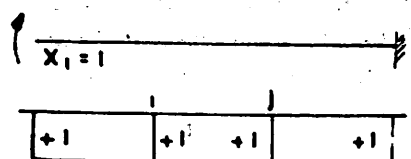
Desplazamientos debidos a hiperestáticas y a acciones externas
